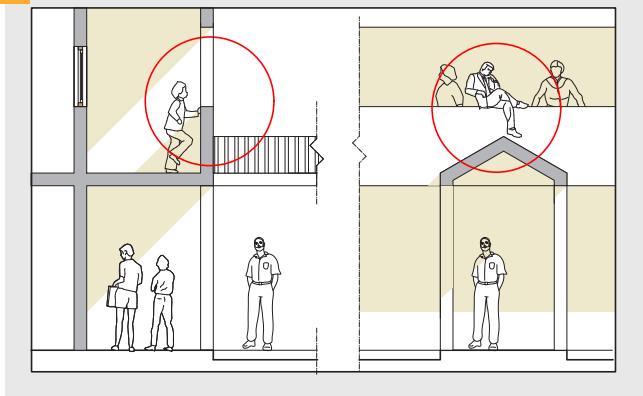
Acceso a cubierta desde corredor cubierto de segundo piso.
